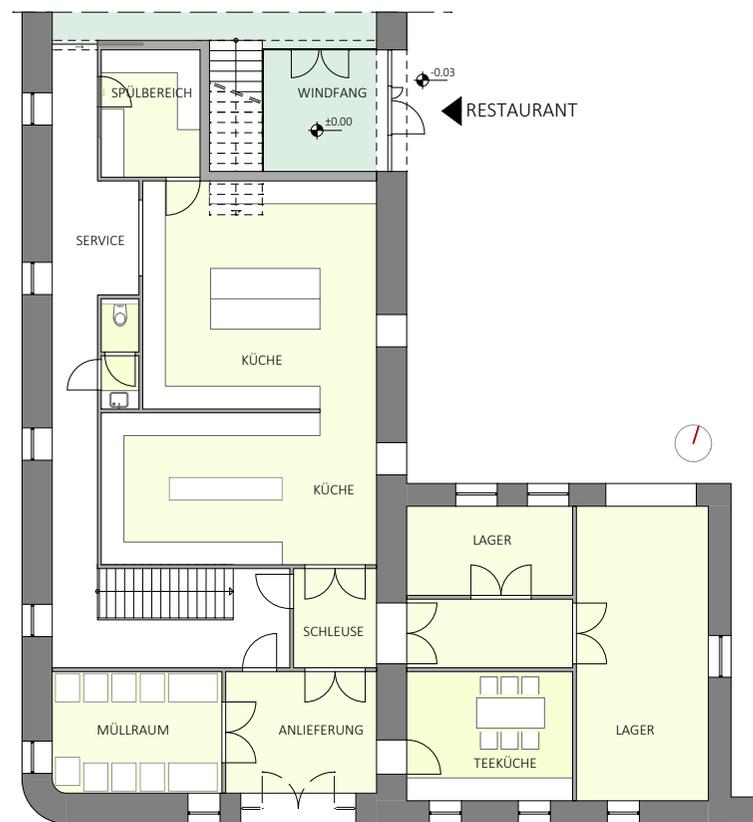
Erdgeschoss Restaurant Küchenbereich, M 1:200
